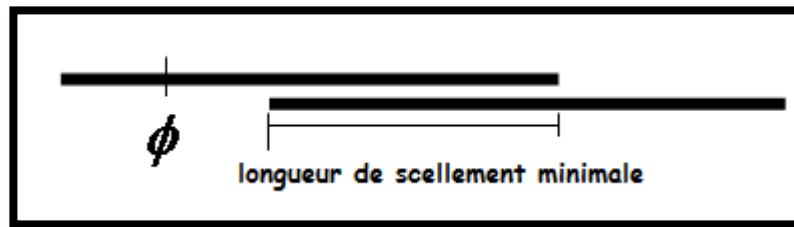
Longueur de recouvrement des aciers dans les poutres.
